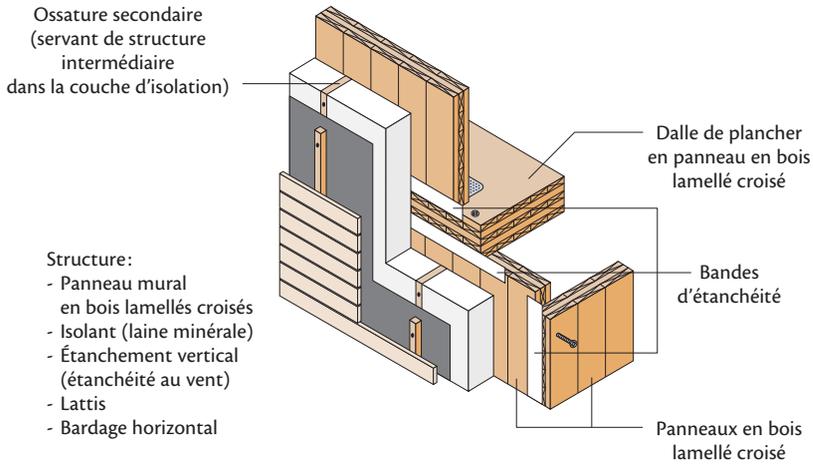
Bardage sur panneaux en bois lamellé croisé
